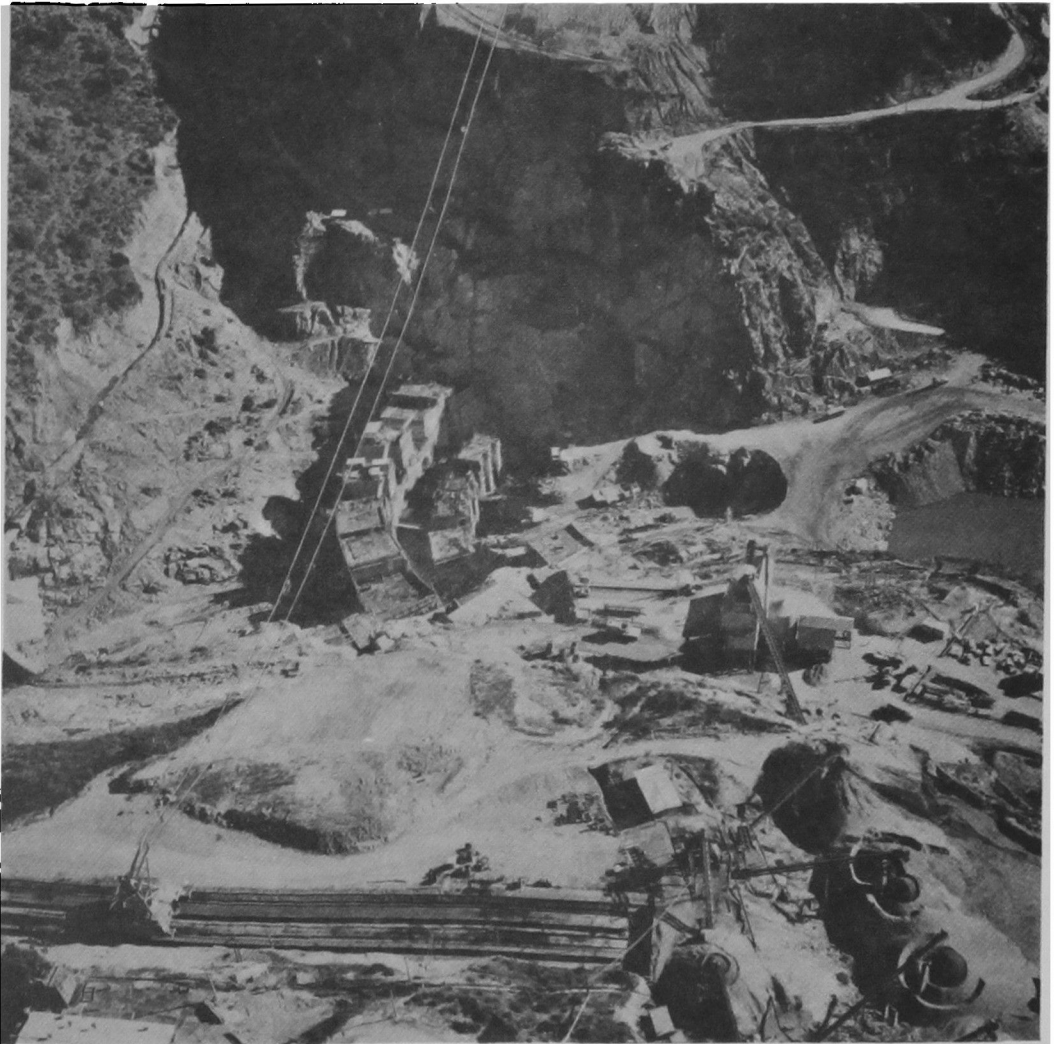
Vista general de las instalaciones de foena. A la derecha, en primer plano, la planta de agregados, y detrás, la torre de hormigón. A la izquierda en primer plano, el cable-riel, y al fondo muro en construcción.
